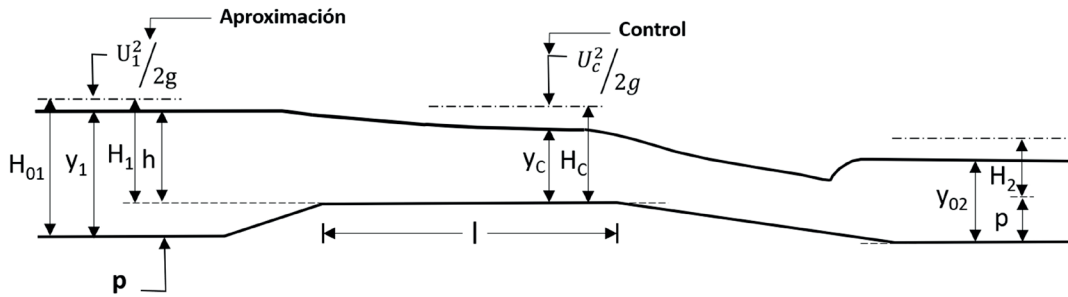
| Sección longitudinal de un aforador modular de estrechamiento largo.
